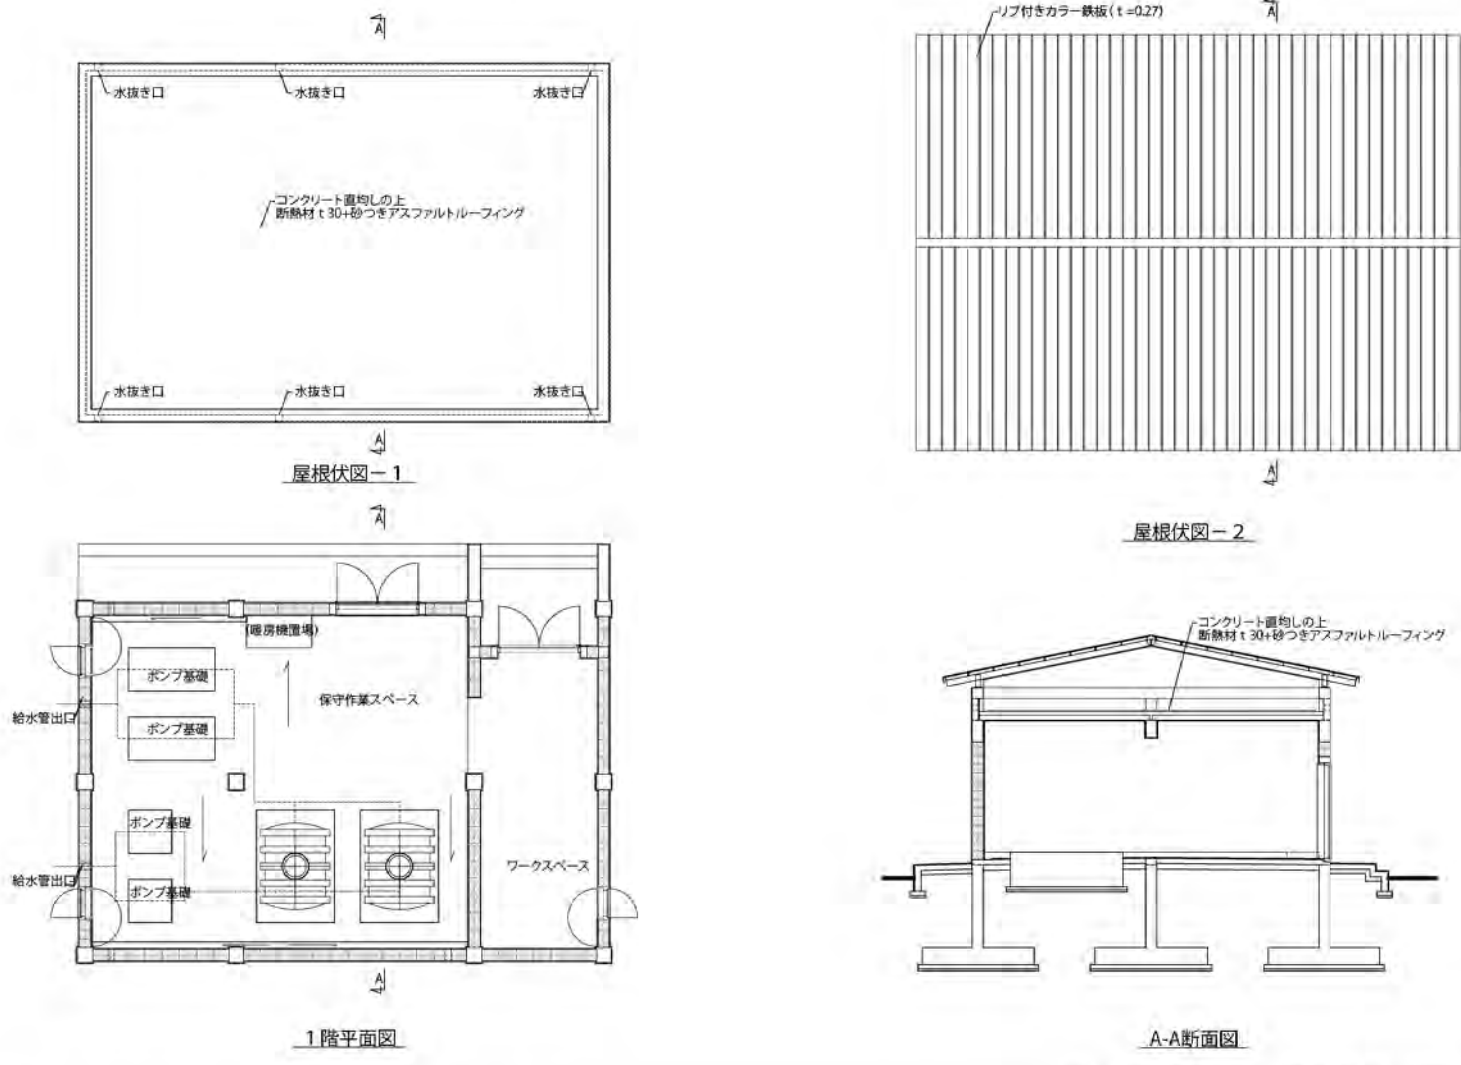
ジョミ郡中央病院 受水槽ポンプ室 平面図・断面図 1/100
